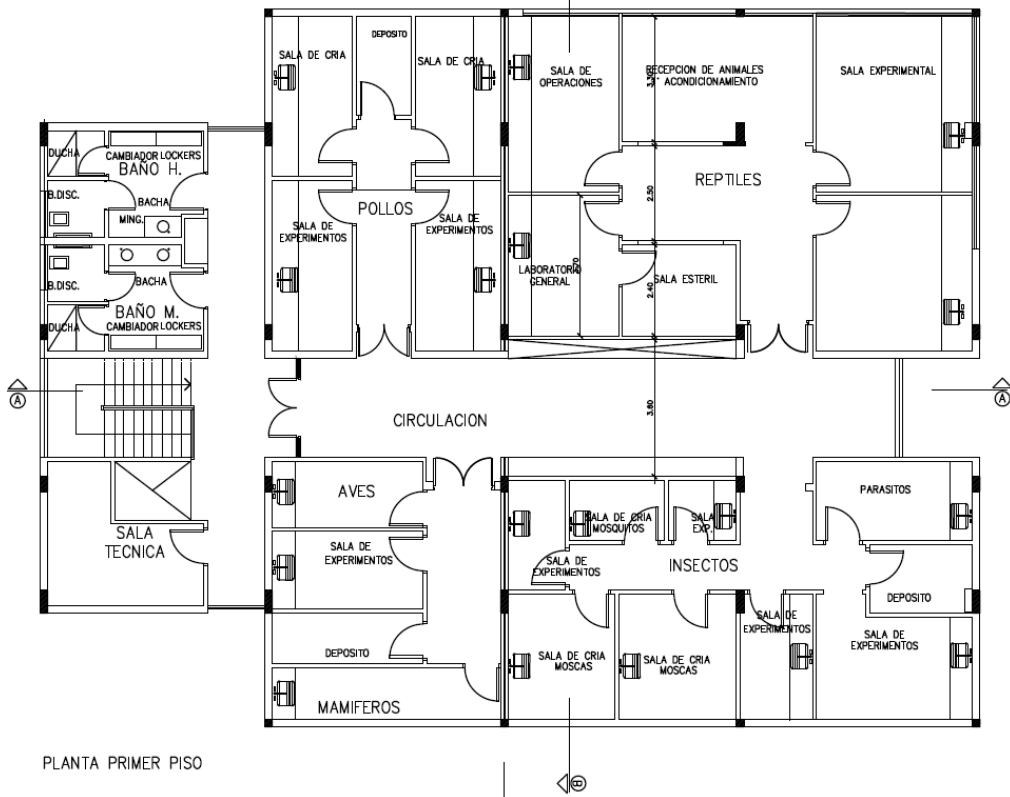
Plano de arquitectura- Edificio Bioterio-Primer Piso
